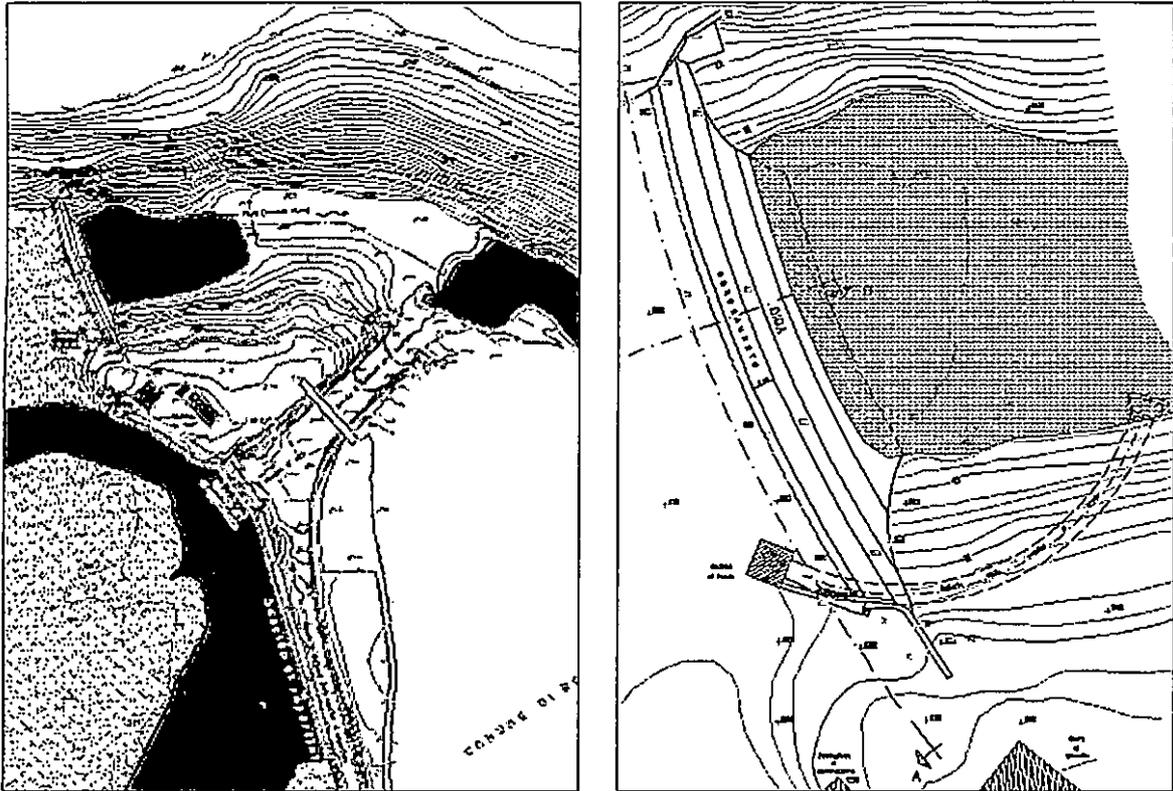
Ante-operam: planimetrie della diga e del bacino di Vulci
